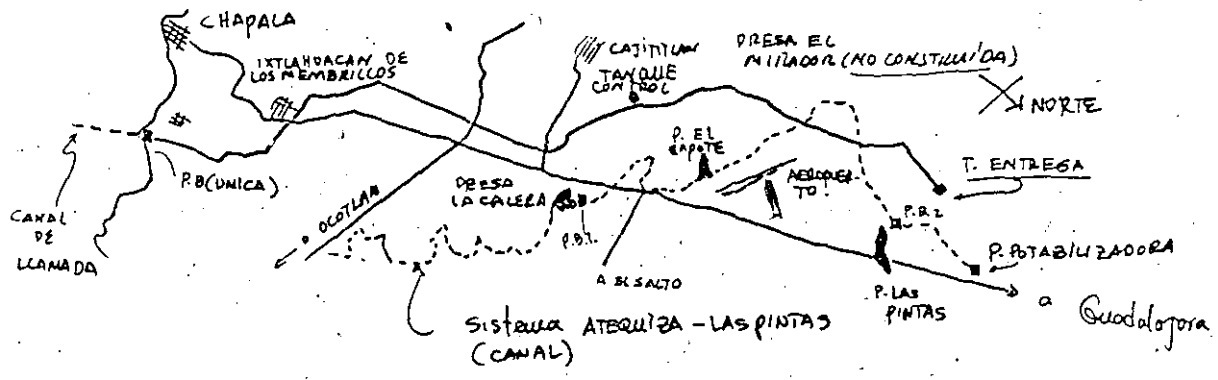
Planta y perfil esquemático acueducto Chapala - Guadalajara, Jal.
